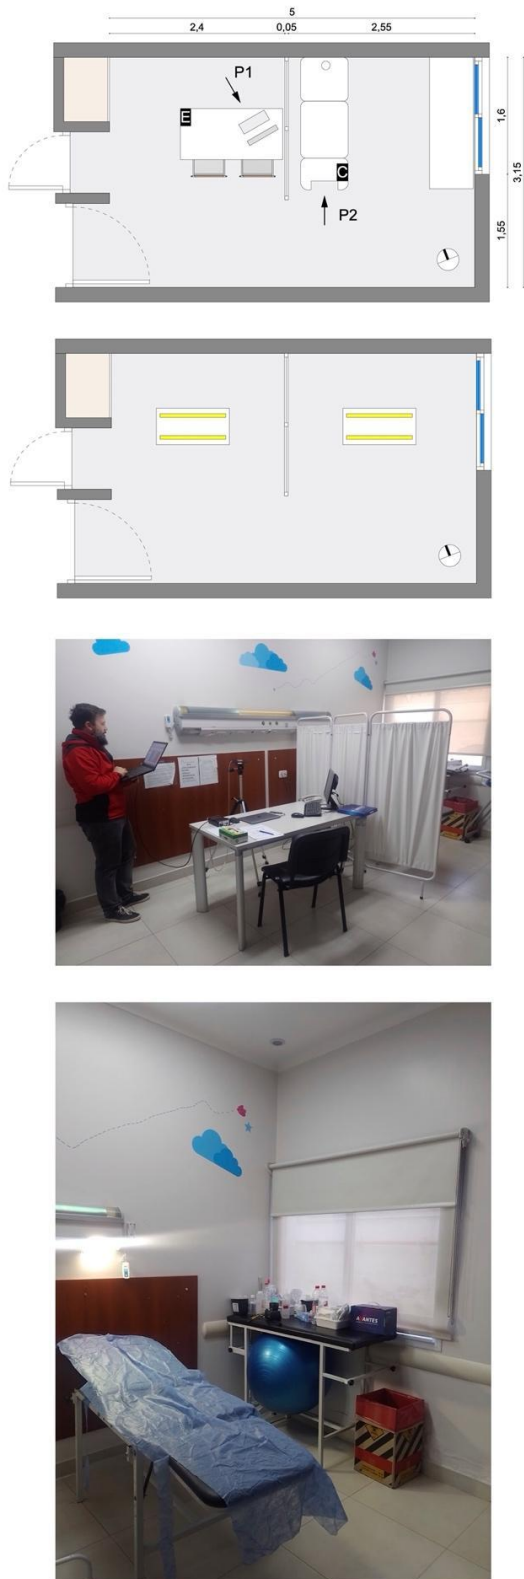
Planta de arquitectura, planta de distribución de artefactos de iluminación y fotos del interior del consultorio.
